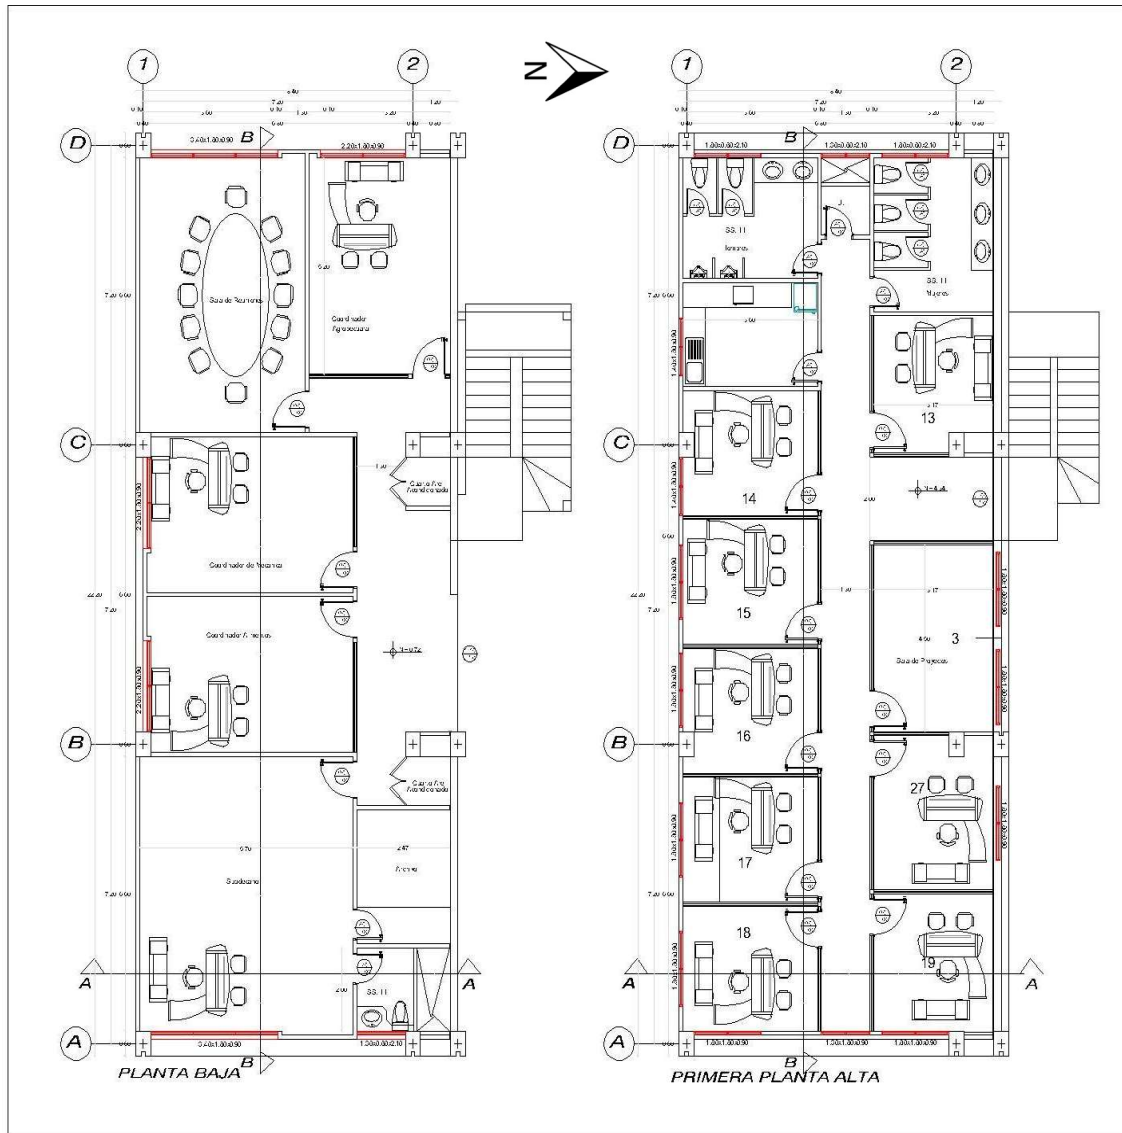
Planos arquitectónicos base de la planta baja y primera planta.
